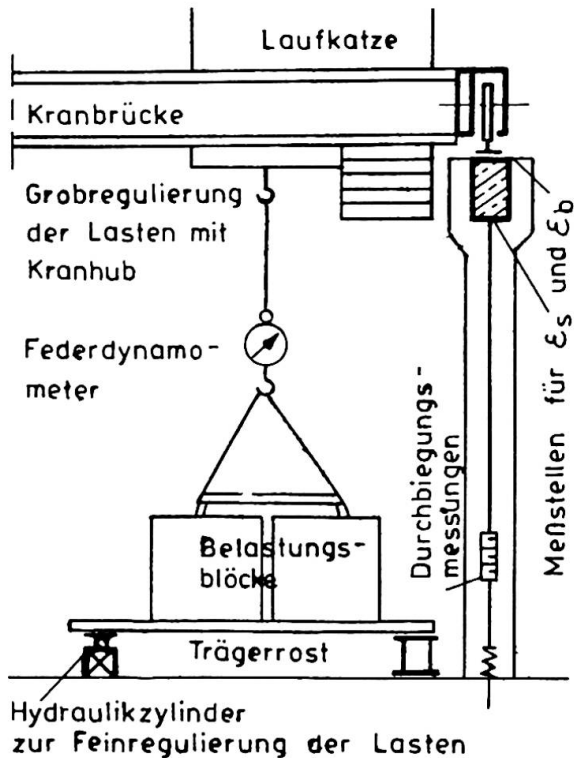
Prüfung eines Stahlbeton-Kranbahnträgers
